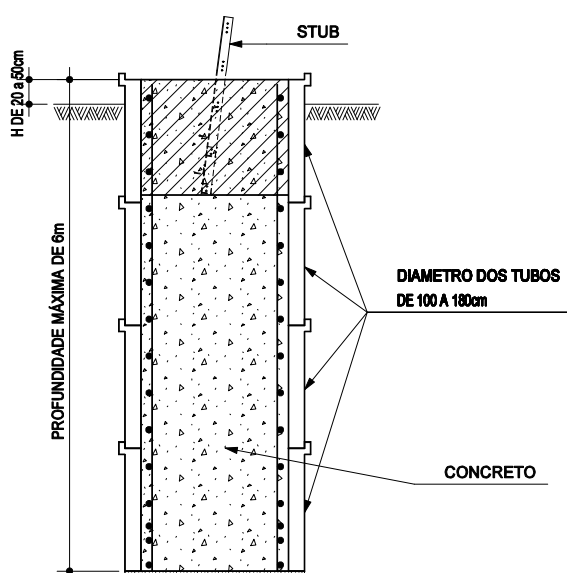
FUNDAÇÃO EM TUBULÃO COM MANILHAS
